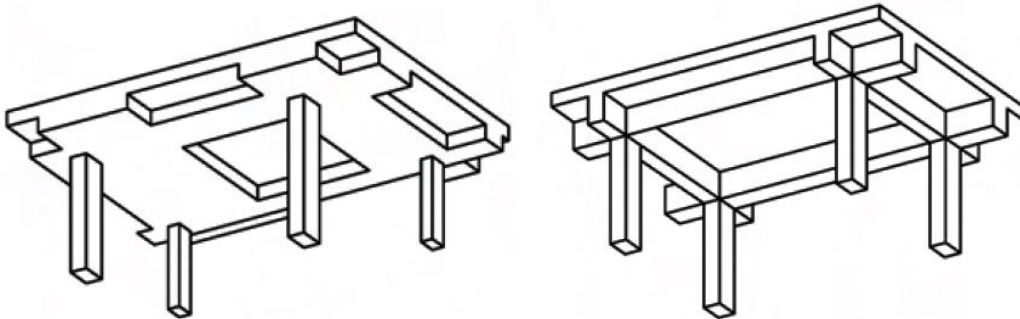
Lajes bidirecionais com vigas planas ou altas [B9]
